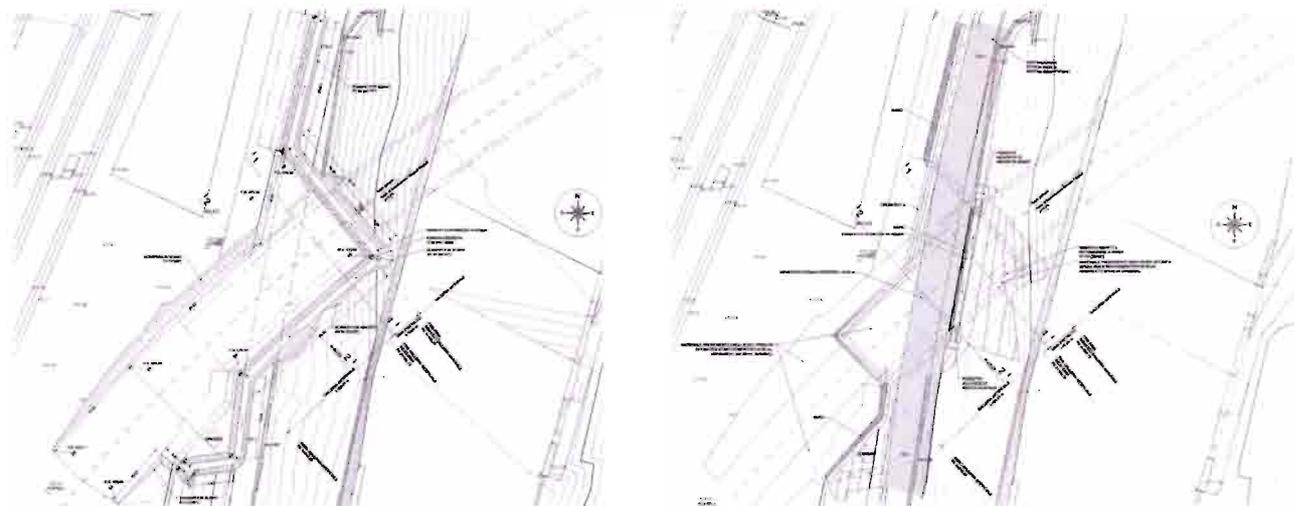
Stralcio planimetrico dell'imbocco dell'interconnessione dispari
